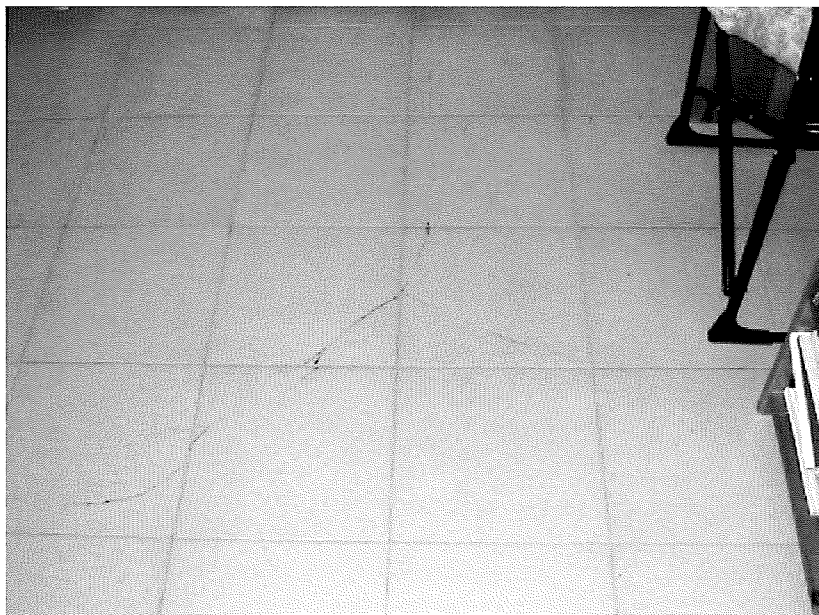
Fisuras de bordes abiertos, en el plano del pavimento.
